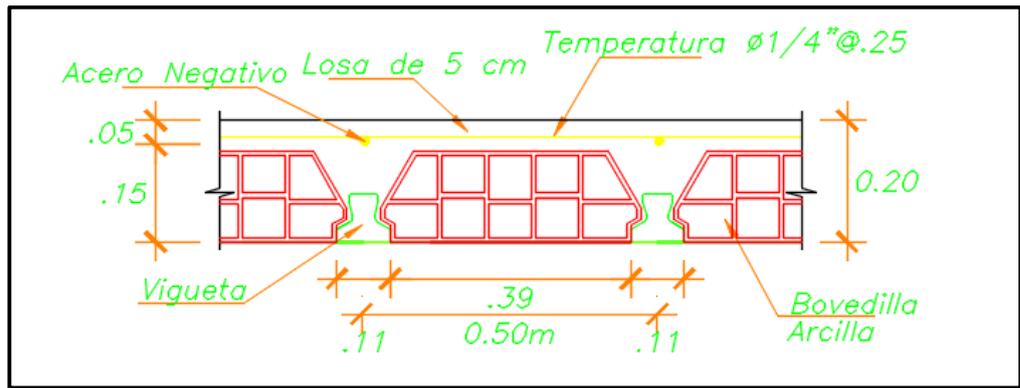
Detalle del sistema de losa aligerada con viguetas pretensadas.
